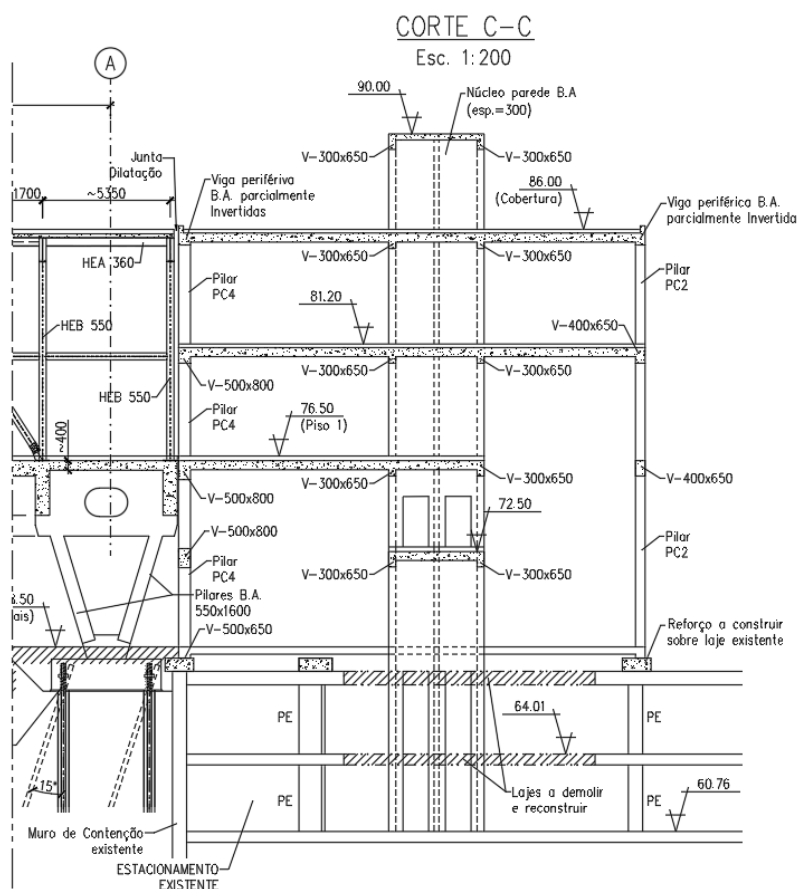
Bloco de acessos verticais a ponte: Corte longitudinal.
